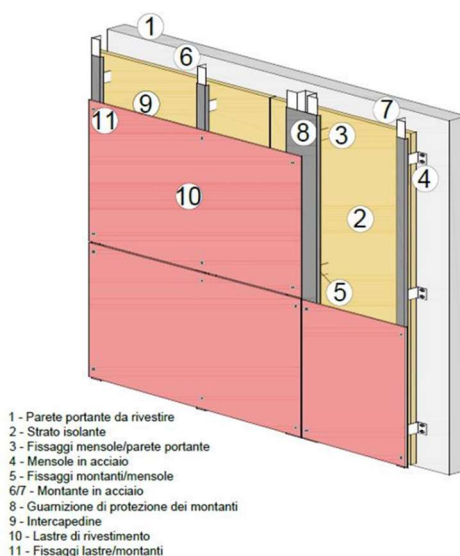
Esempio di un pacchetto di facciata ventilata con sottostruttura di acciaio, montato sulla parete portante
